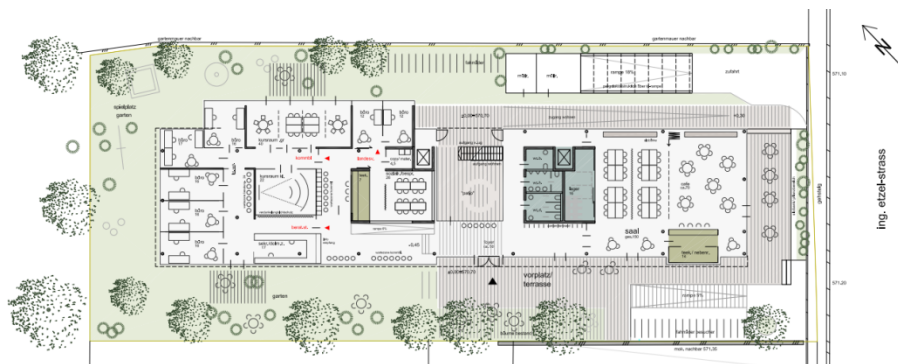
Grundriss Erdgeschoß vom Siegerprojekt des Architektenwettbewerbes
